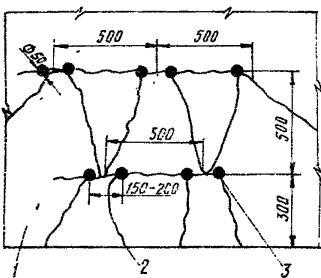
Характер разрушения бетонного фундамента с предварительно пробуренными отверстиями (шпурами)
